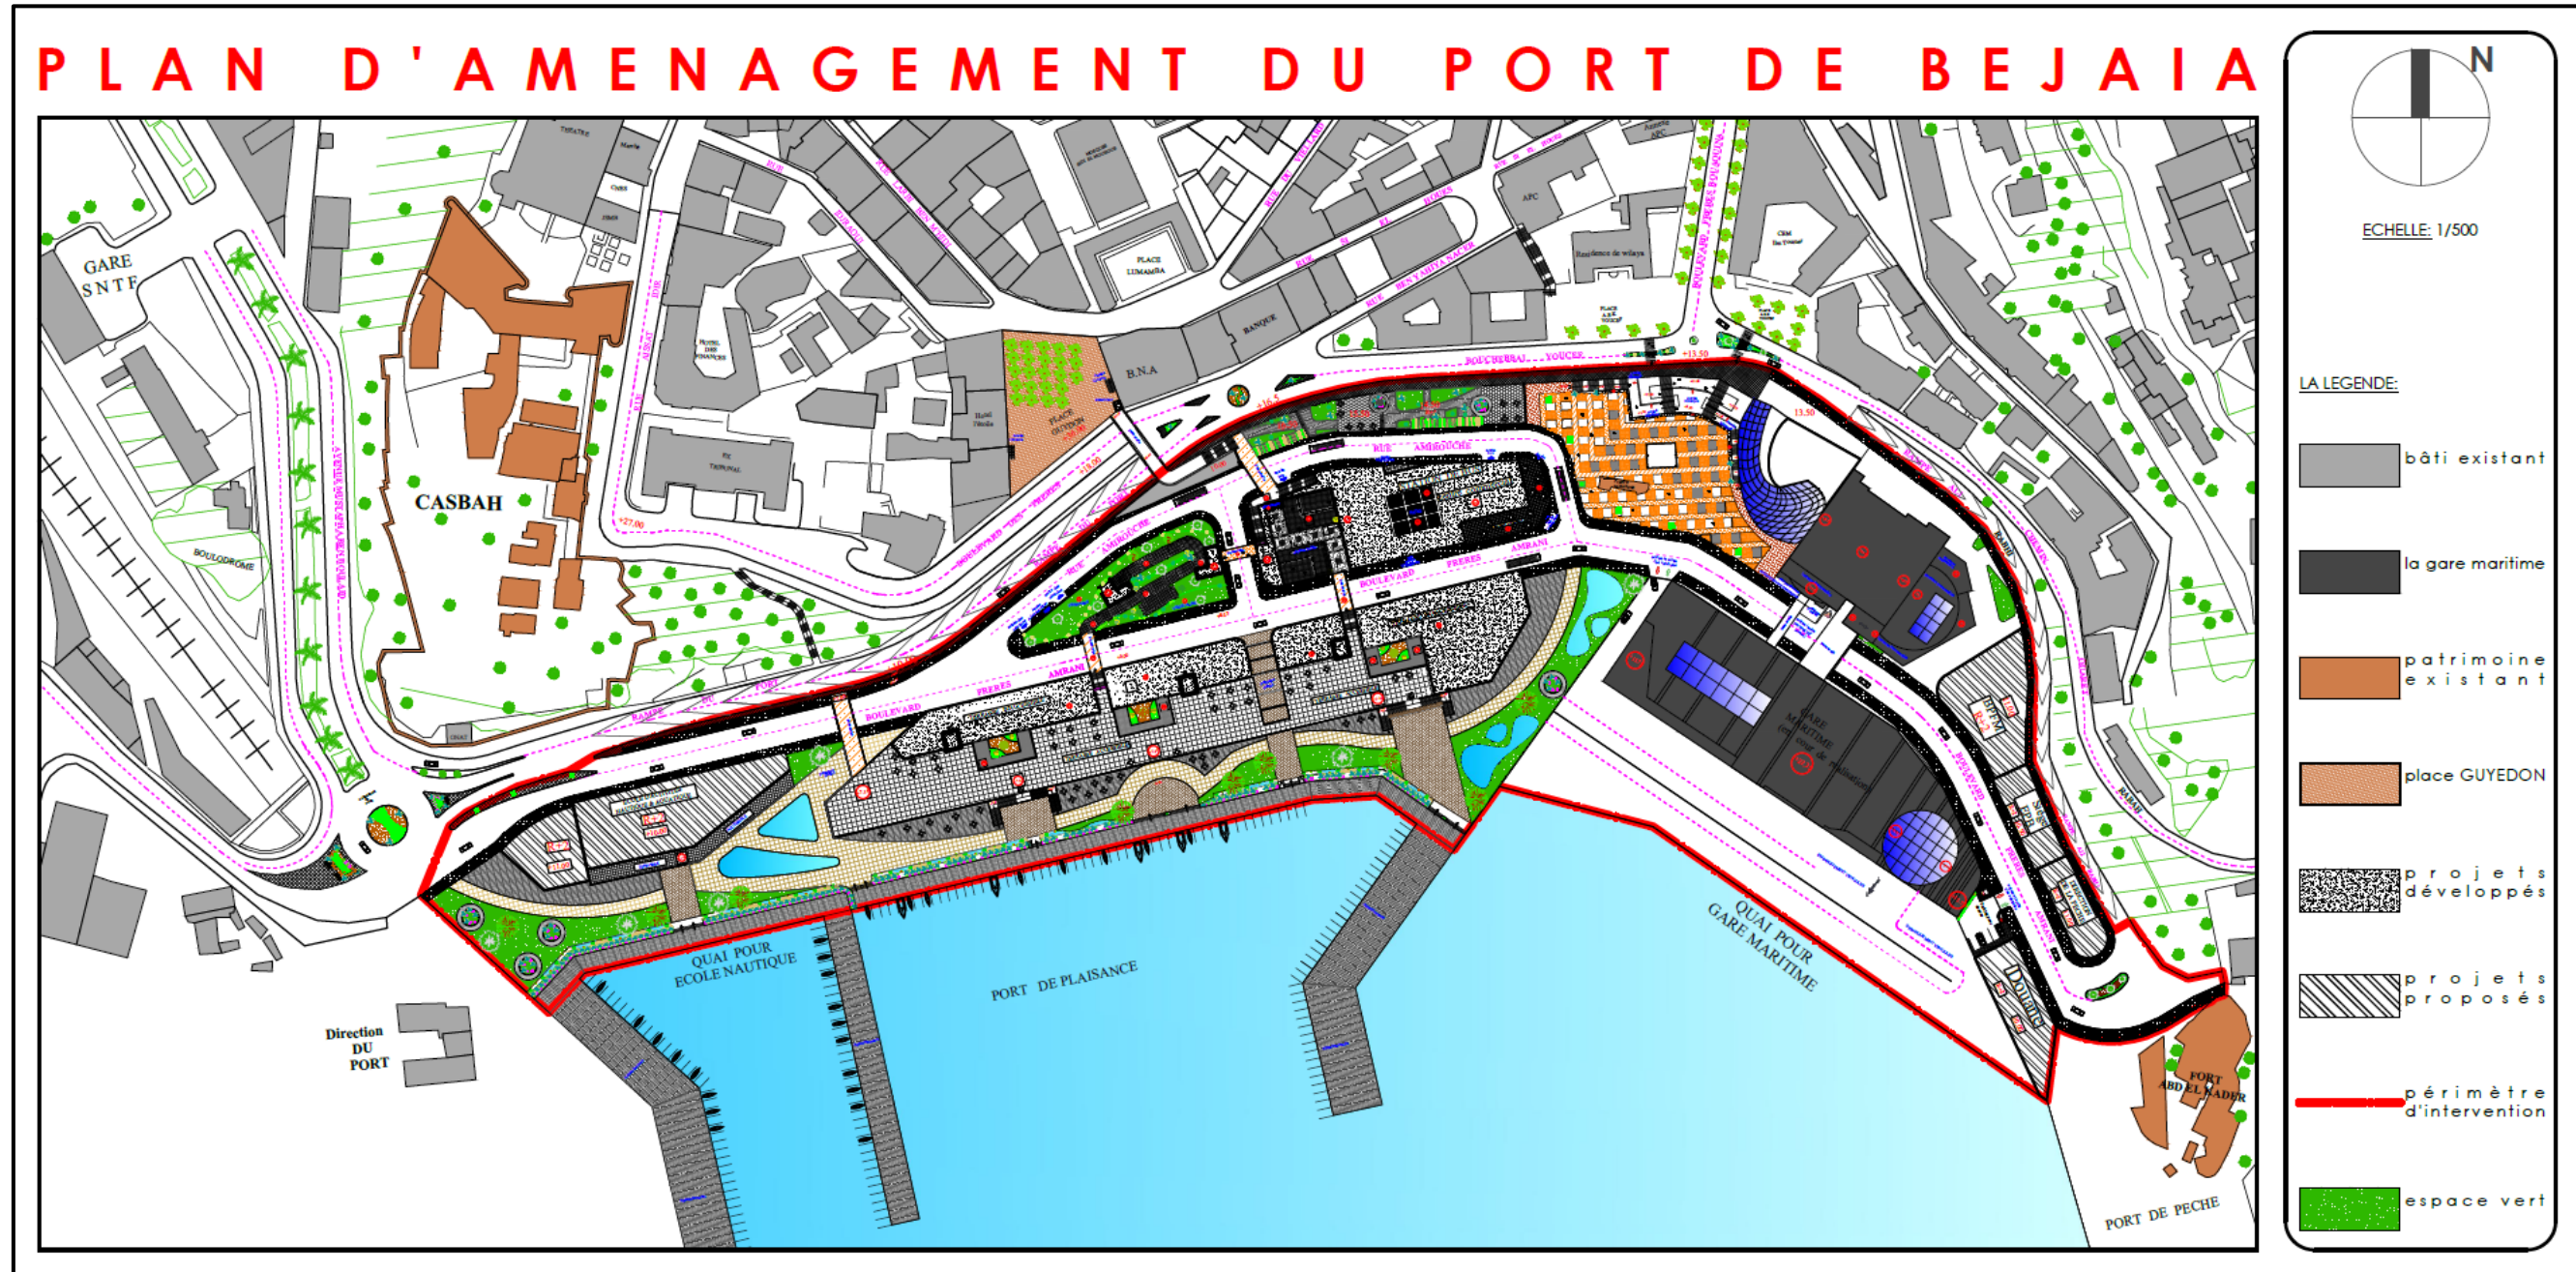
PLAN D'AMENAGEMENT « Source : travail personnel »
